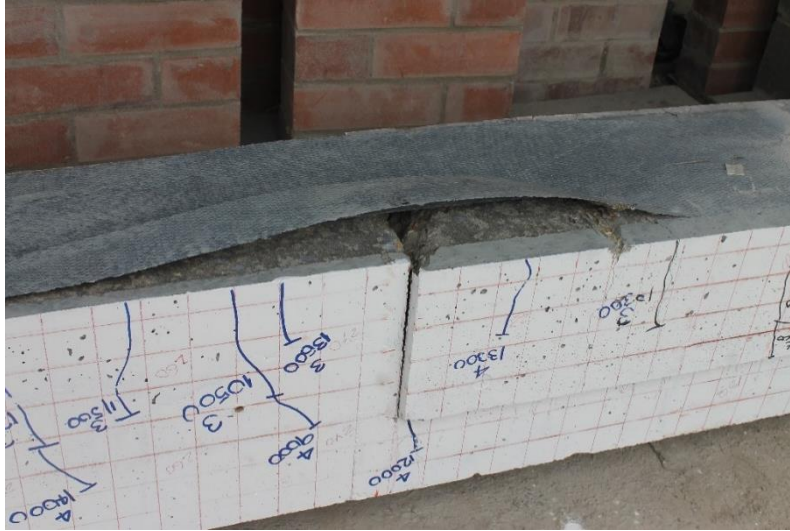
Fisuras en la cara en tracción de la viga V7
